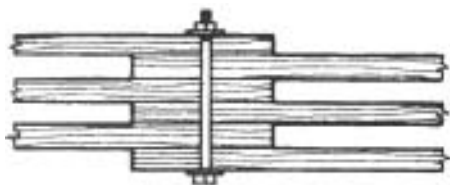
Unión emperrada sometida a cizallamiento múltiple
